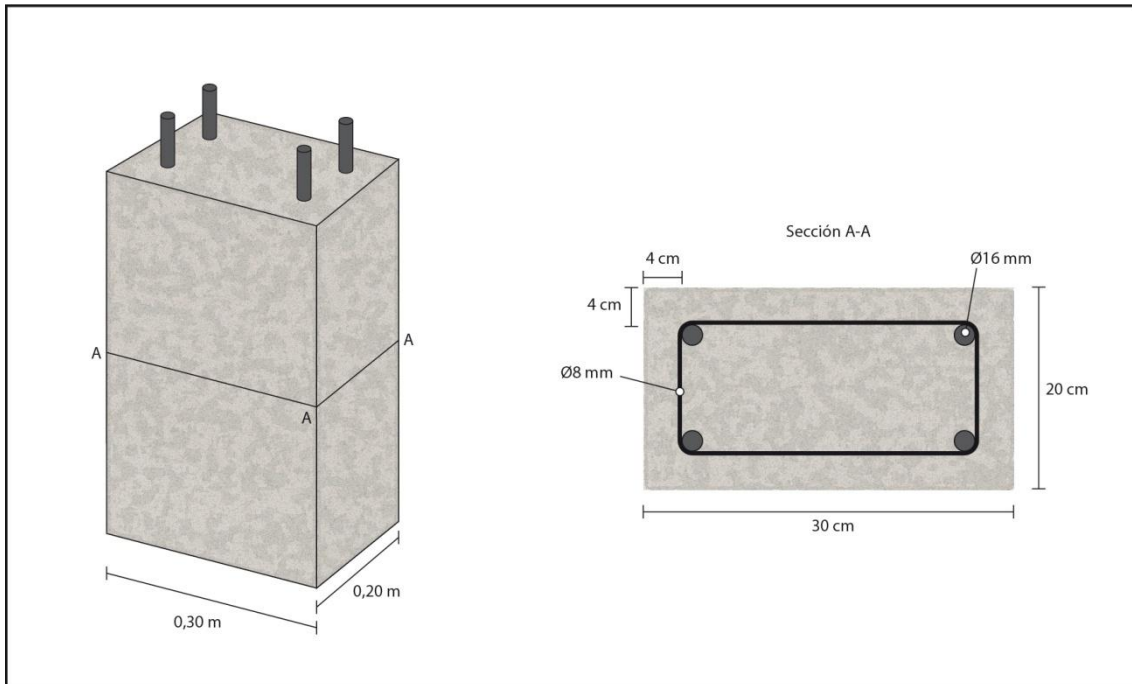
Dimensiones y características de las probetas tipo soporte de sección rectangular de hormigón armado.
